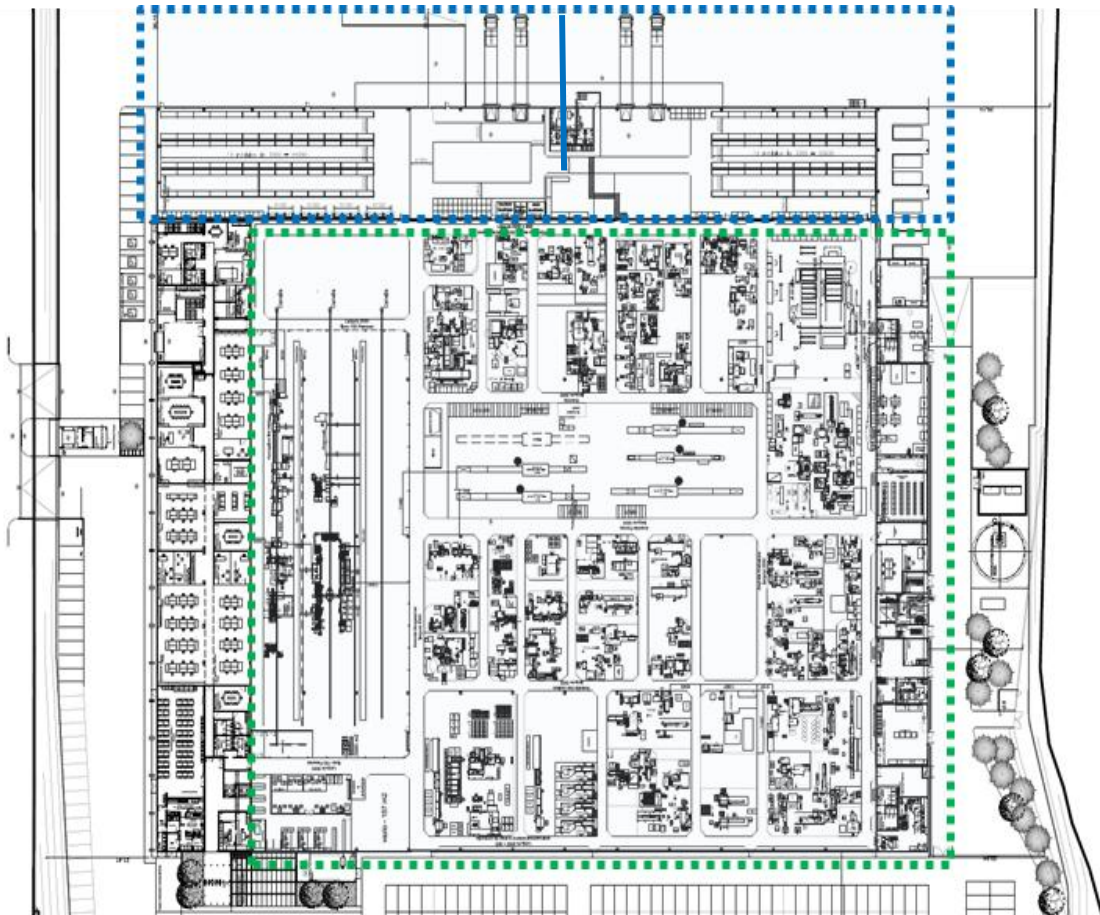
Layout Provisório da nova fábrica em Lanheses.
